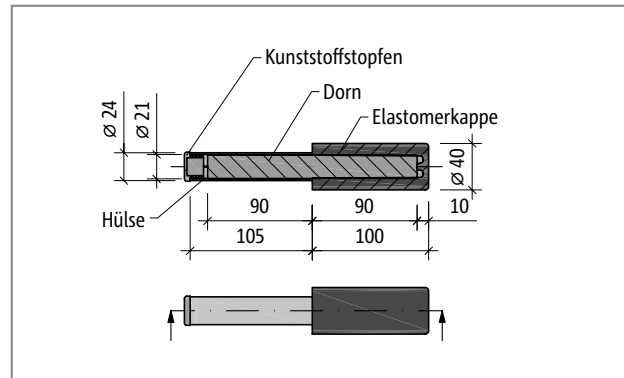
Schöck Tronsole® Typ D-H: Produktgrundriss
